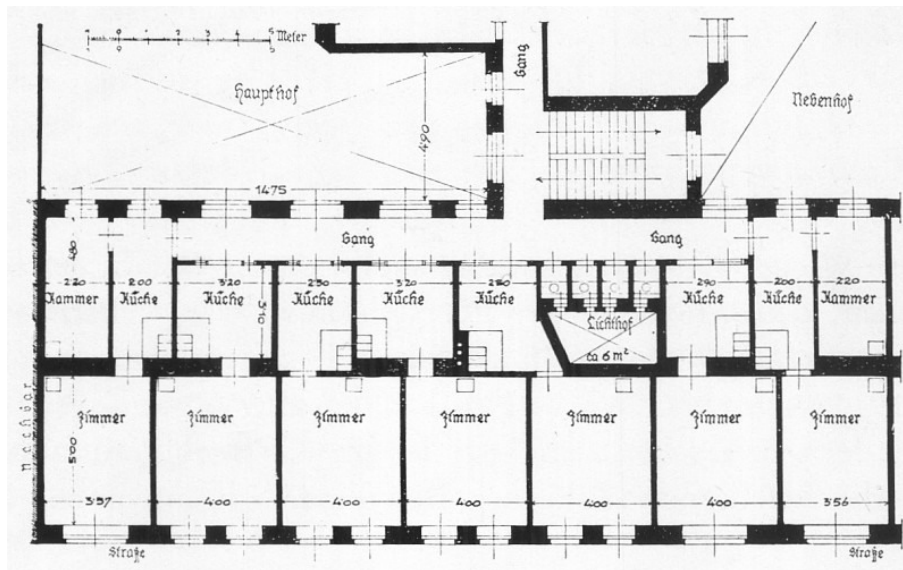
Stockwerksgrundriss eines Gangküchenhauses
